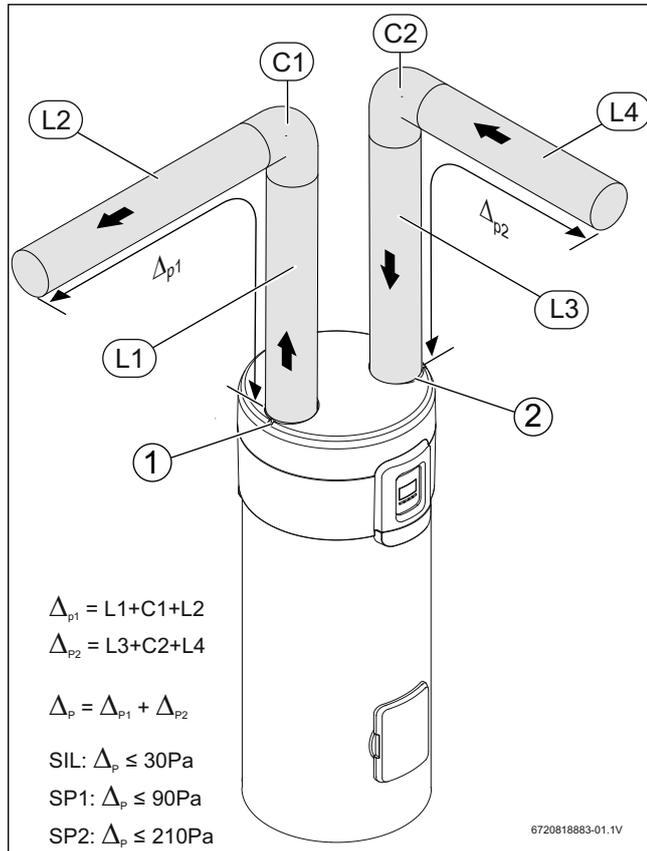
Druckverlust (Pa) für Compress 5000 DW
